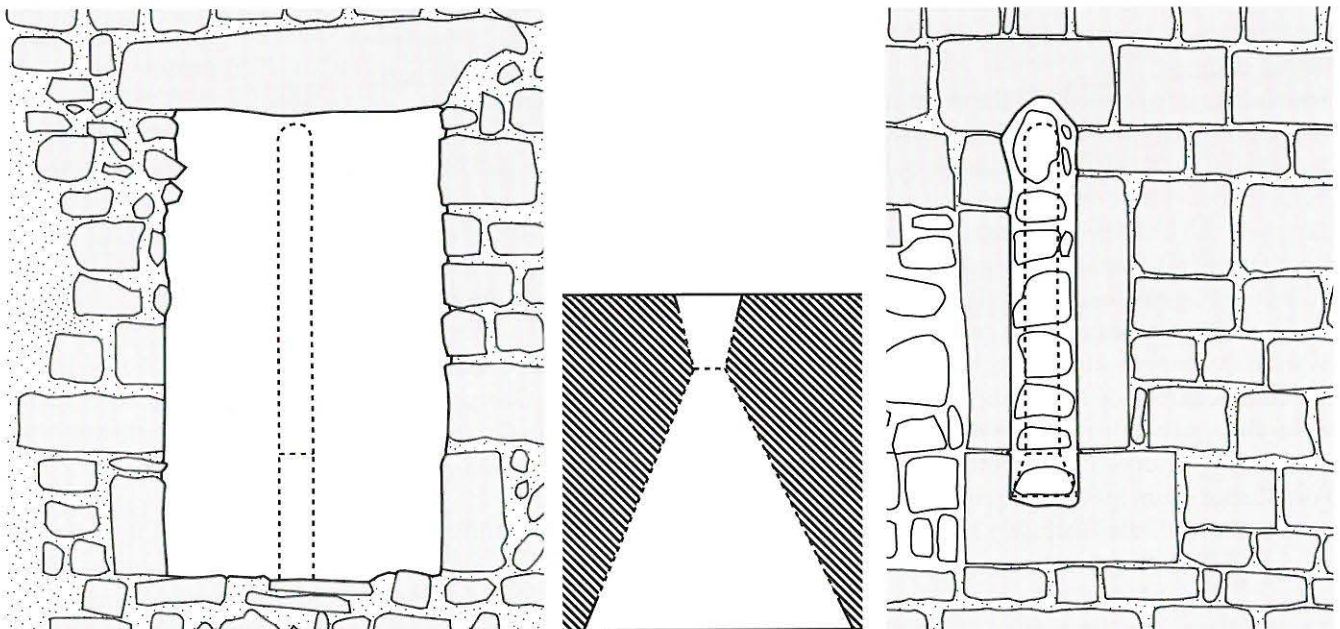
Luzide (130.4) des Westflügels. Innenansicht, Grundriss und Aussenansicht. M 1:20.
